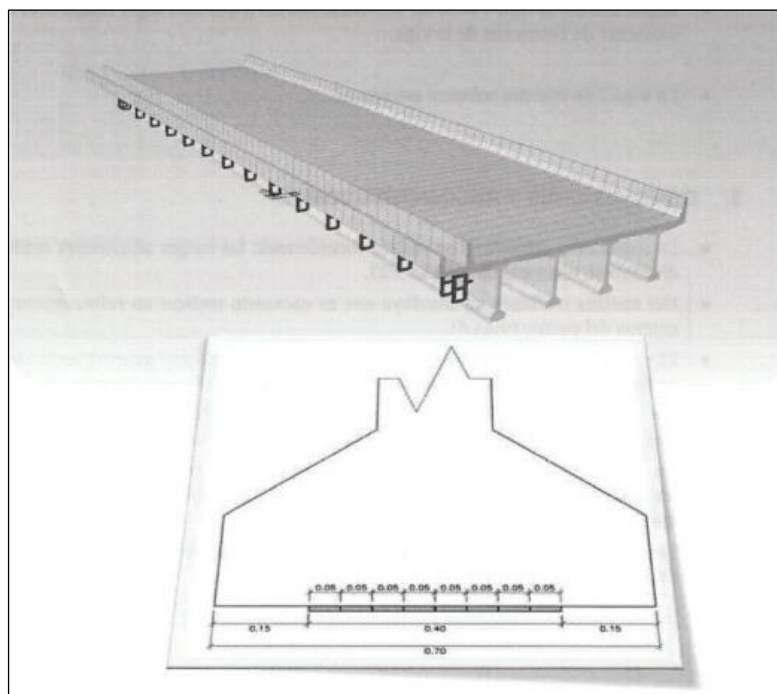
Ubicación de láminas de refuerzo en la Viga 4 del puente Antahuacana
